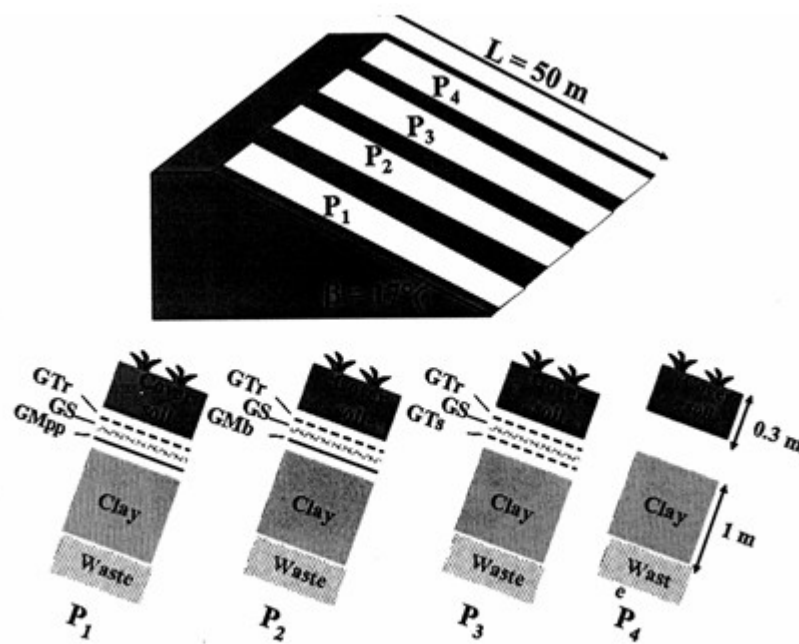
Constitution des 4 planches d'essai de la barrière de couverture sur pente (Ramirez, 2003).
